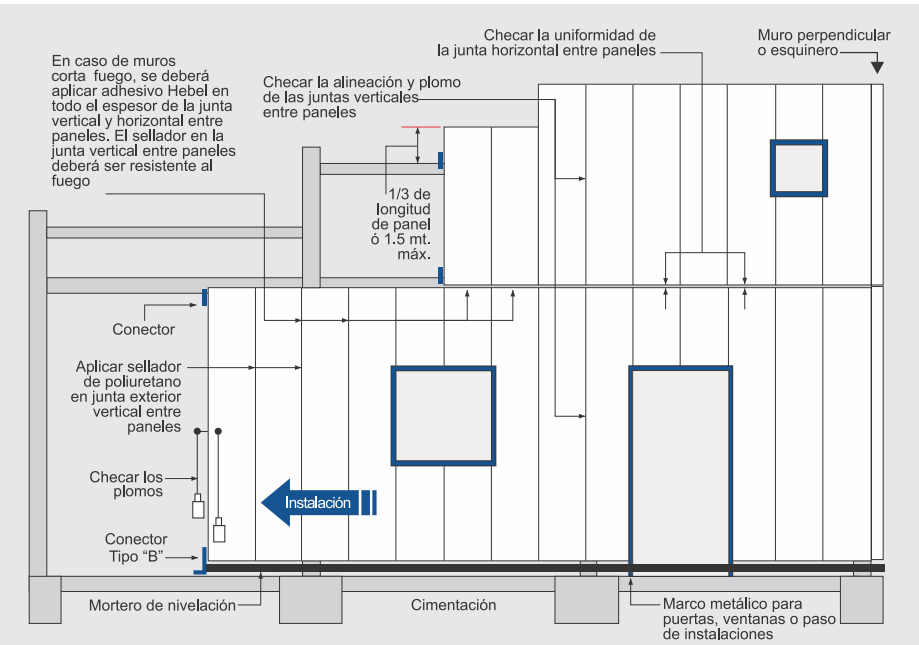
Tablero tipo con arreglo vertical de paneles para muro sobre estructura de acero.
